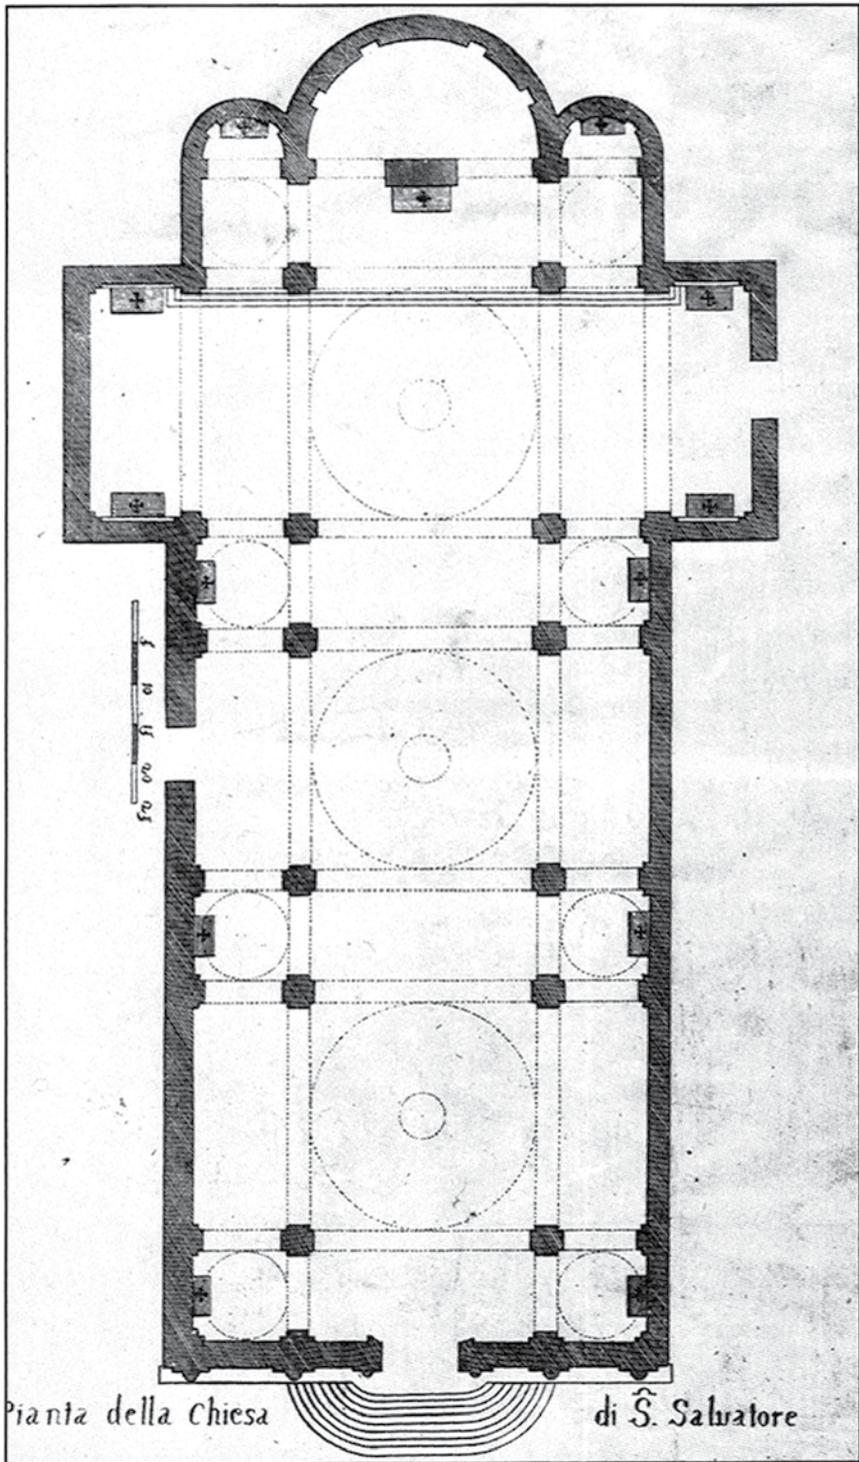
San Salvador, planimetria (da CONCINA 2009).
